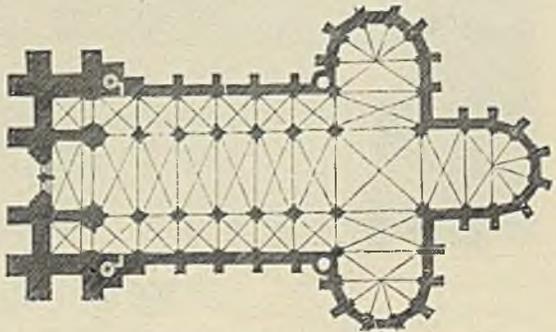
Grundriß der Elisabethkirche zu Marburg
